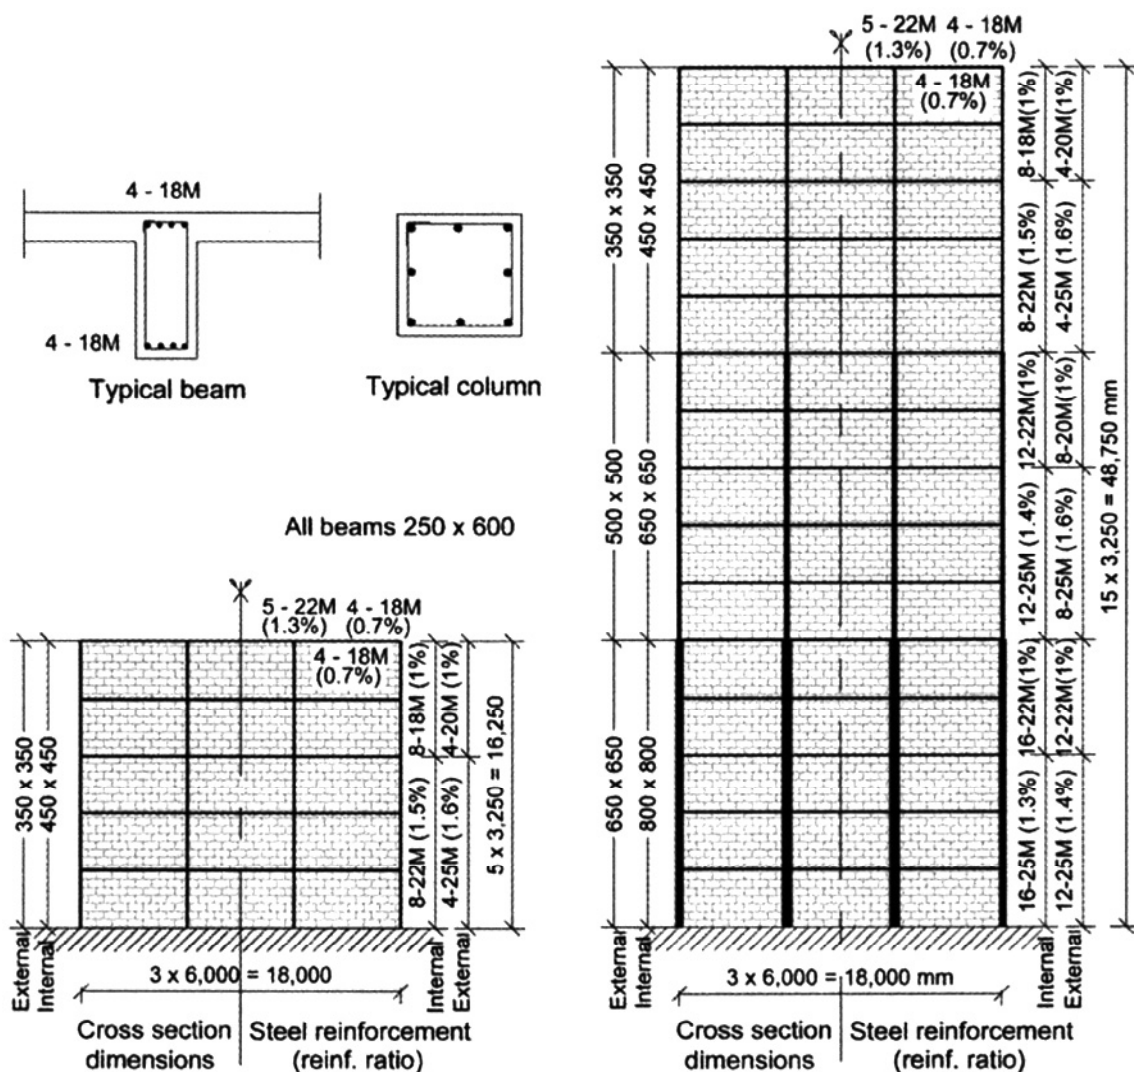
Elevațiile structurilor în cadre din beton armat cu 5, respectiv 15 niveluri
